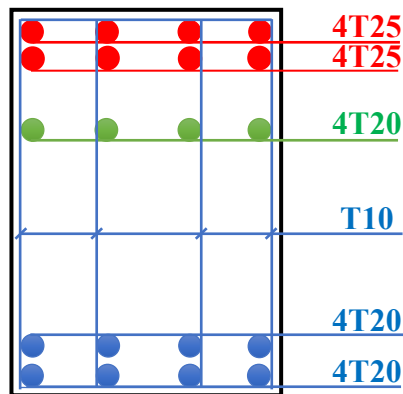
Ferrailage de la poutre de libage (sens longitudinal)
